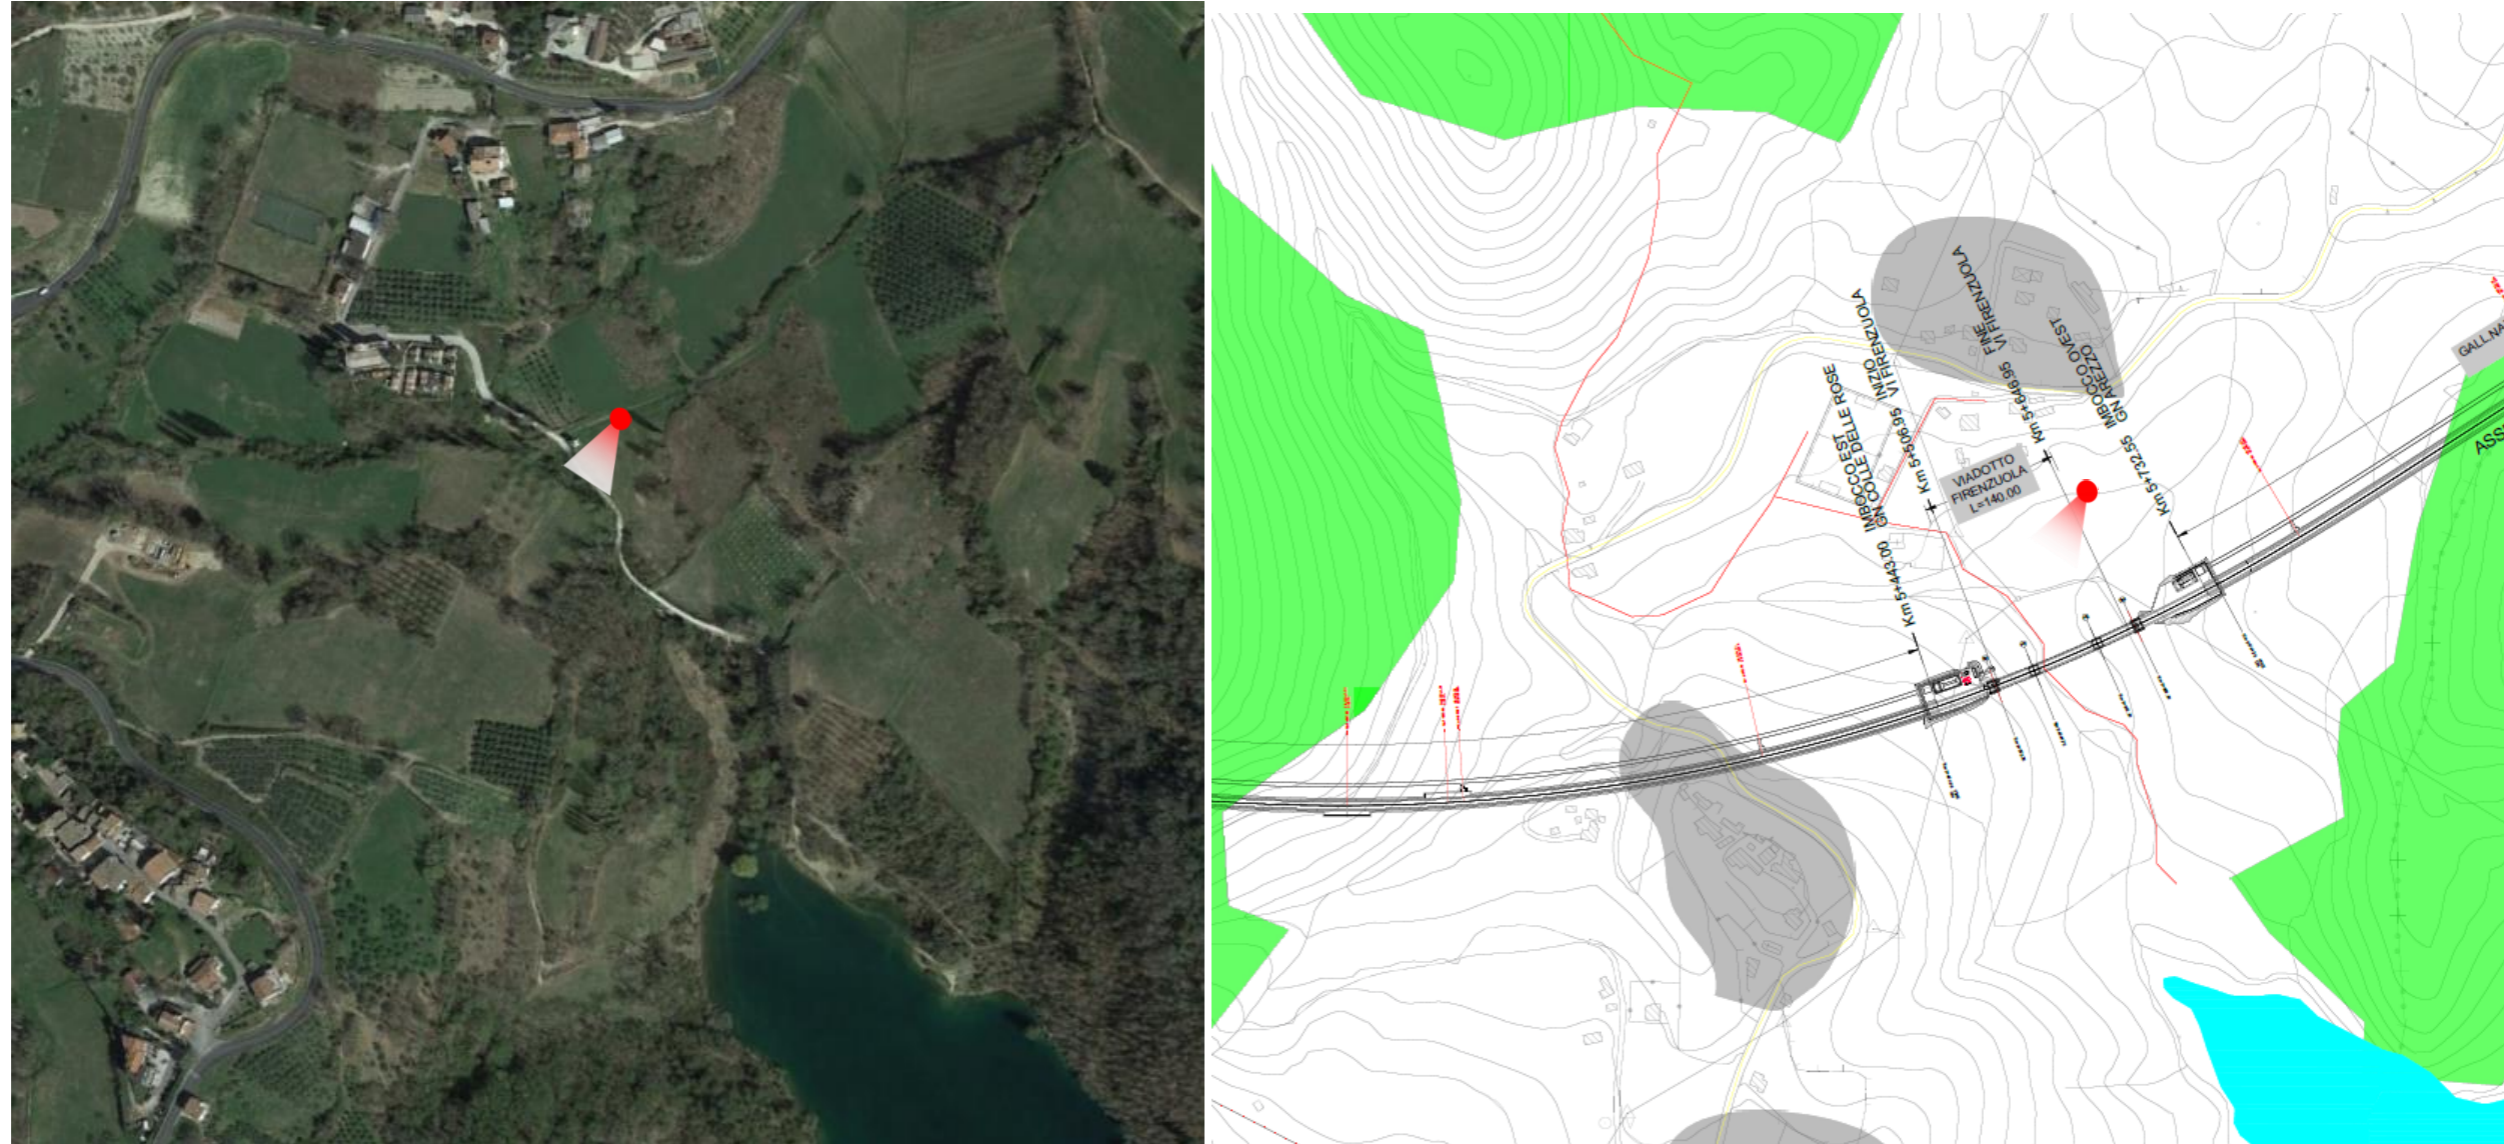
Rappresentazione del punto di vista del fotoinserimento 3 su ortofoto e su planimetria di progetto
